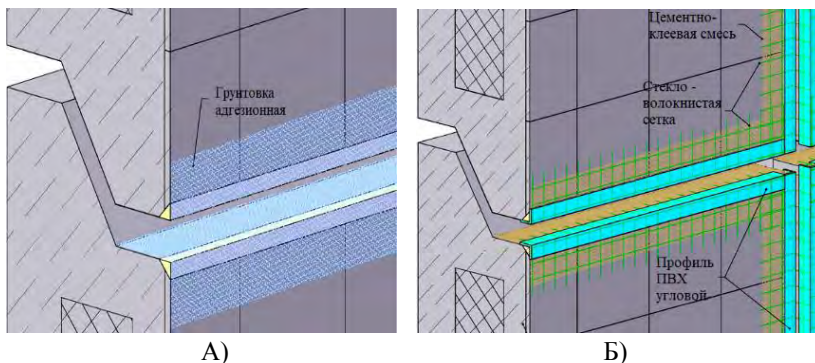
(А) - грунтование восстановленных швов стеновых панелей; (Б) - армирование межпанельного шва угловым профилем из ПВХ с фасадной сеткой.
